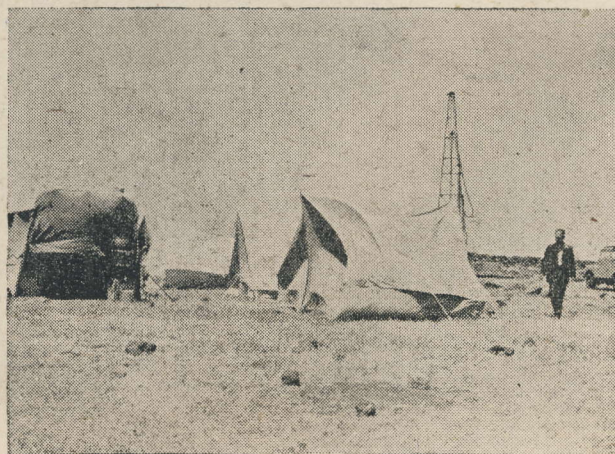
Detalj s bušenja bunara bušilicom Failing
